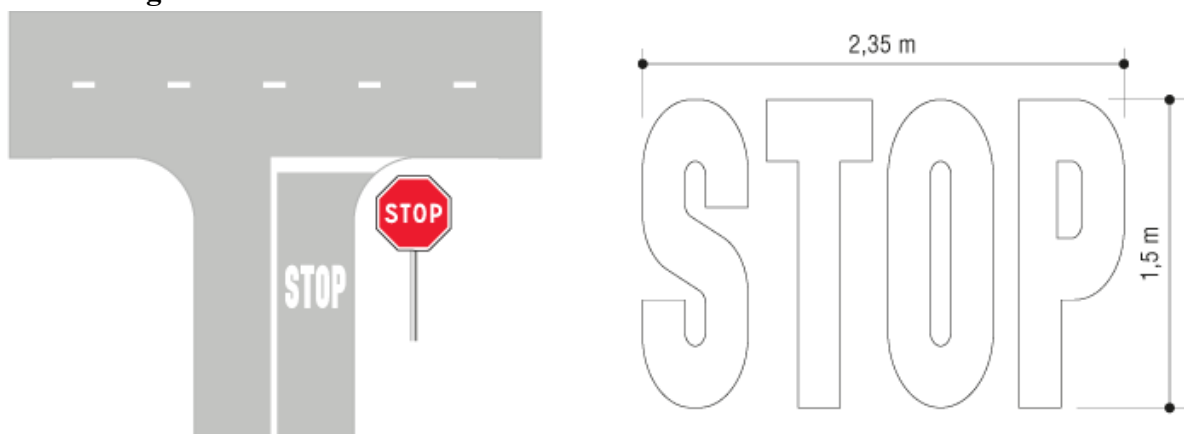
Schéma de signalisation STOP sur chaussée.
